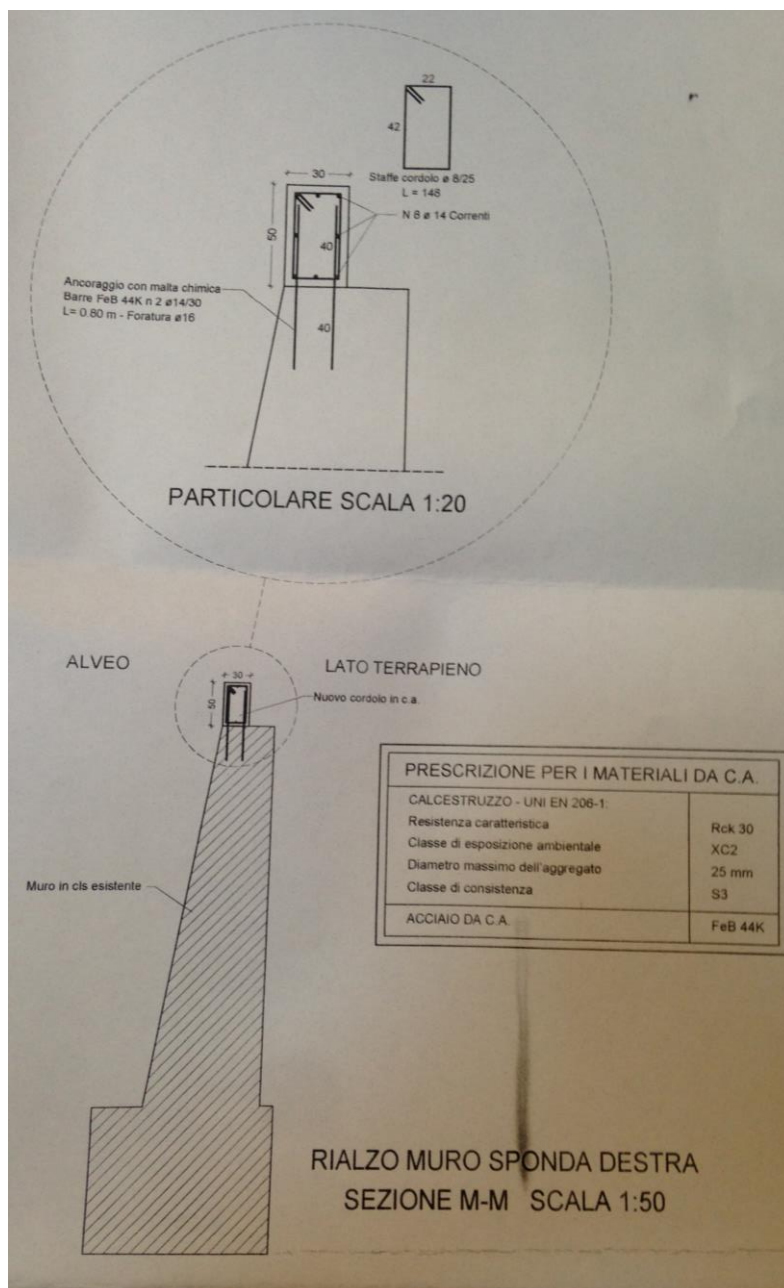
Sezione – Estratto Pratica Sismica N. 613/2009
